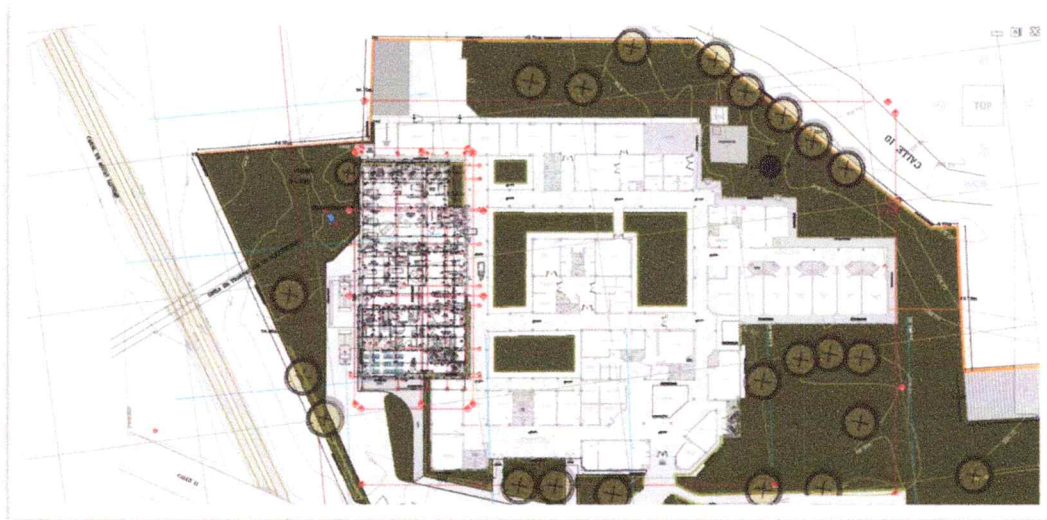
Plano de distribución arquitectónica del proyecto dentro del Hospital Nelson Restrepo
